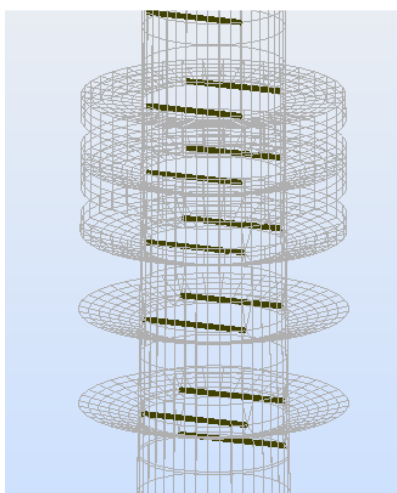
Vigas metálicas de suporte às escadas e de contraventamento.
